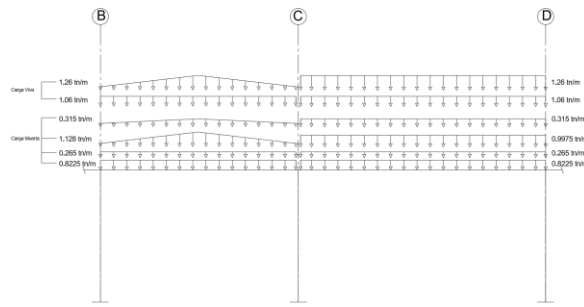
Vista de perfil de cargas de gravedad de la viga 75 (30x60)
